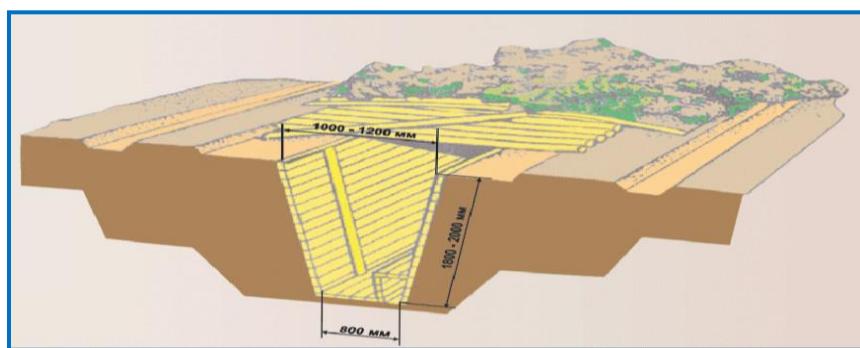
Перекрытая щель (схема щели и ее устройство)
